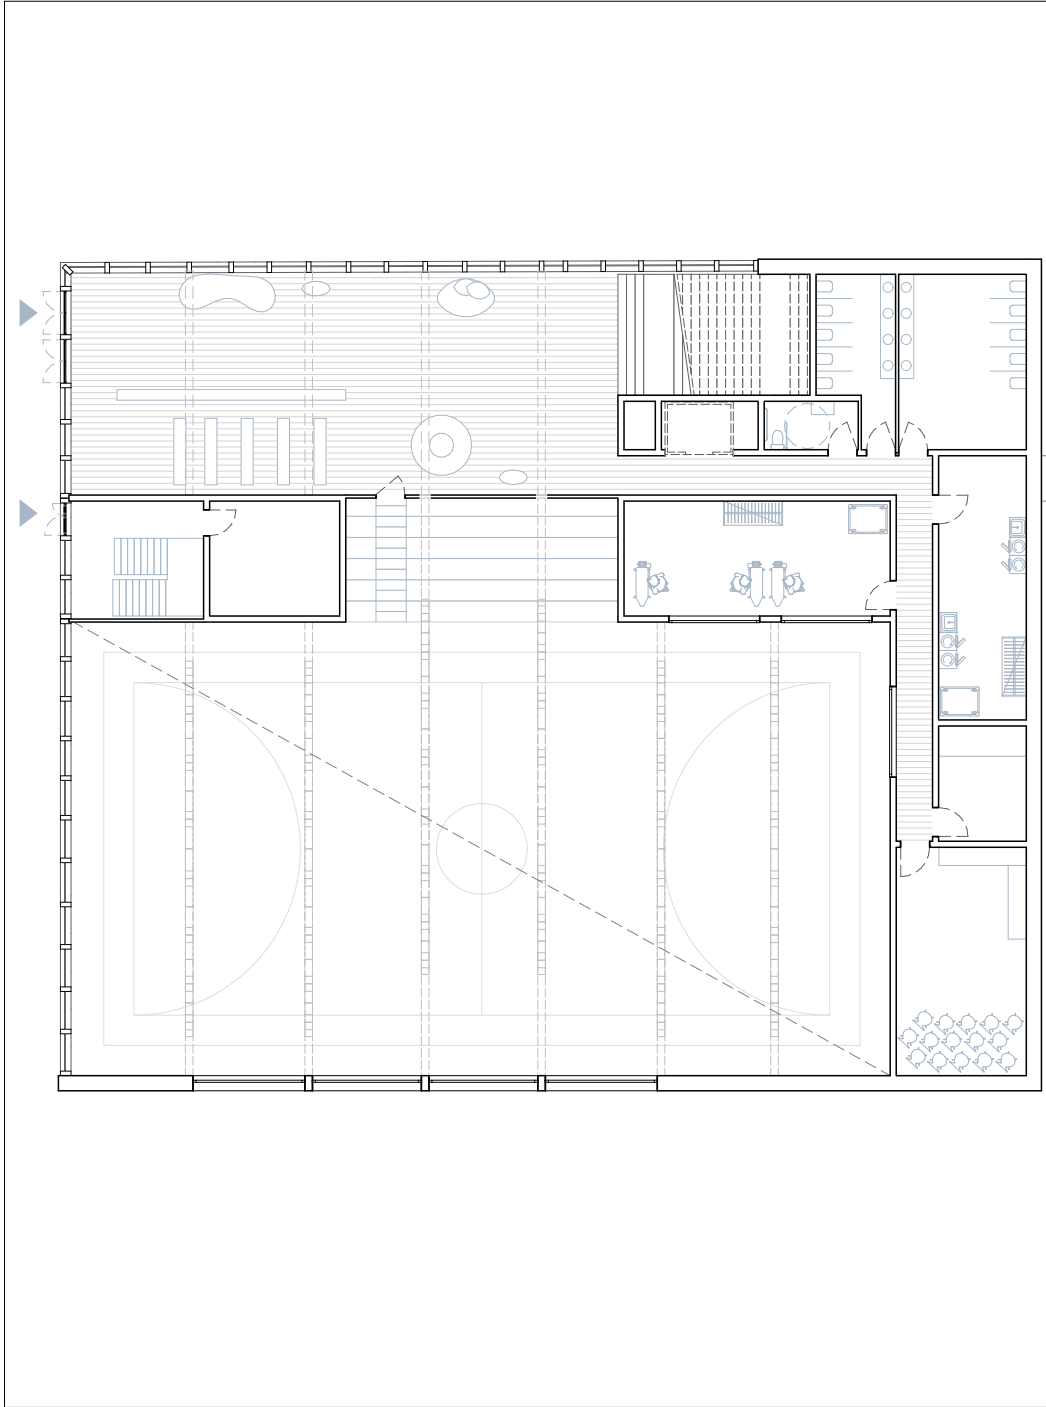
Grundriss EG Straße Veranstaltungshalle
